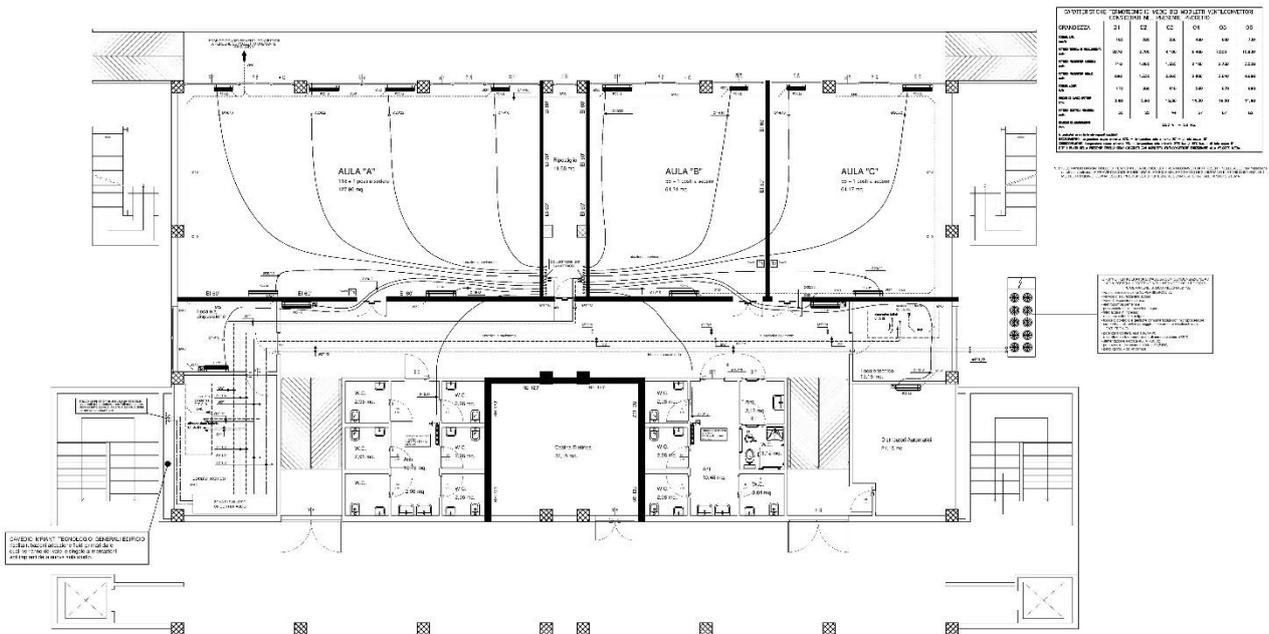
Distribuzione della rete Fancoil al Piano Terra
